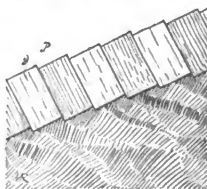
Coupe verticale d'une rampe pavée en bois.
